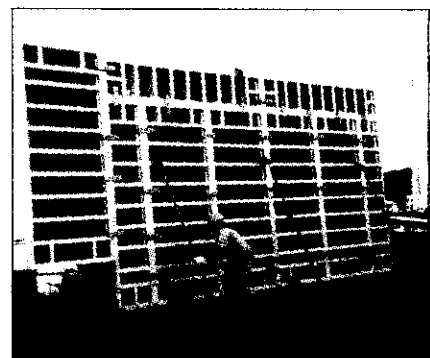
Установка щитов опалубки горизонтально и со смещением относительно друг друга при бетонировании высоких стен
